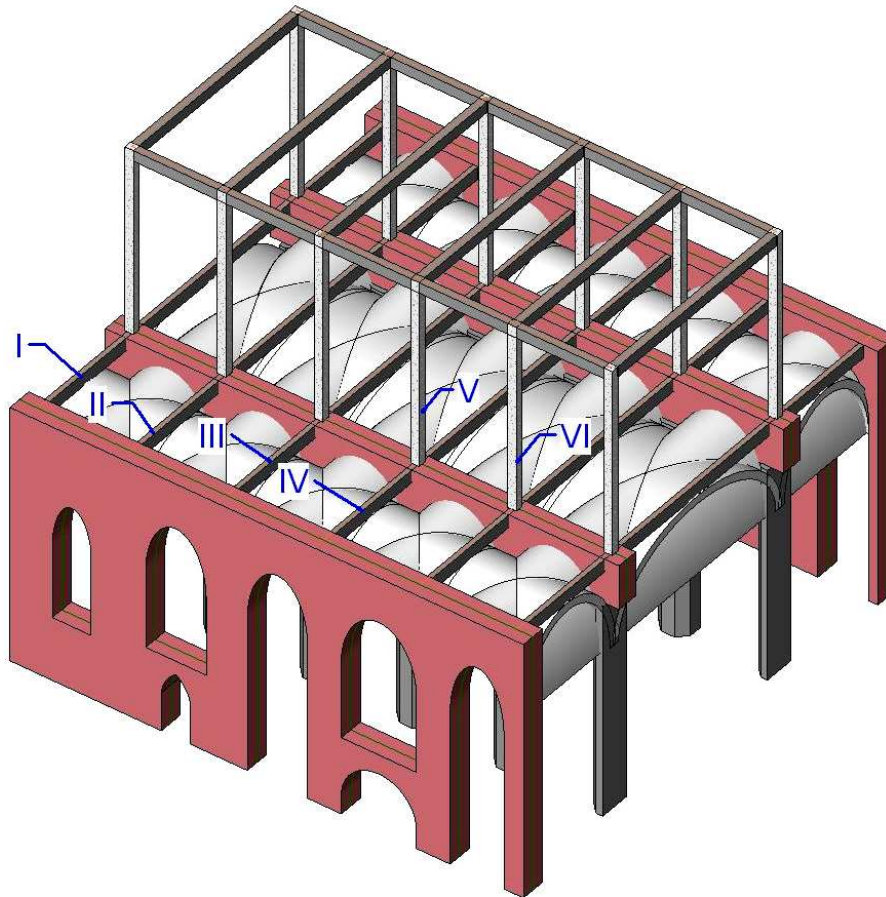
Widok odwiertów próbek do badań laboratoryjnych pobrane z belek rusztu i słupów ram
